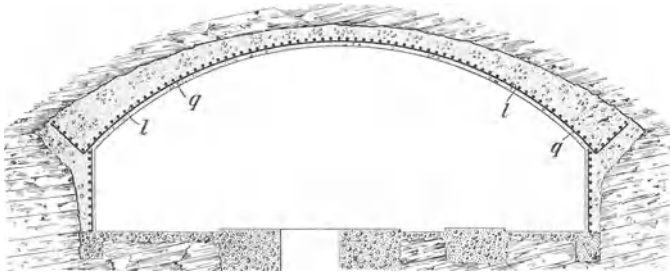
Ausbau einer Pumpenkammer in Eisenbeton.
